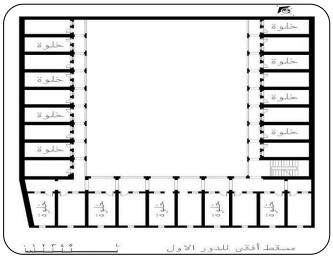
مسقط أفقي تصوري لمدرسة داود باشا في ضوء وصف وثيقة الوقف (عمل الباحث)
